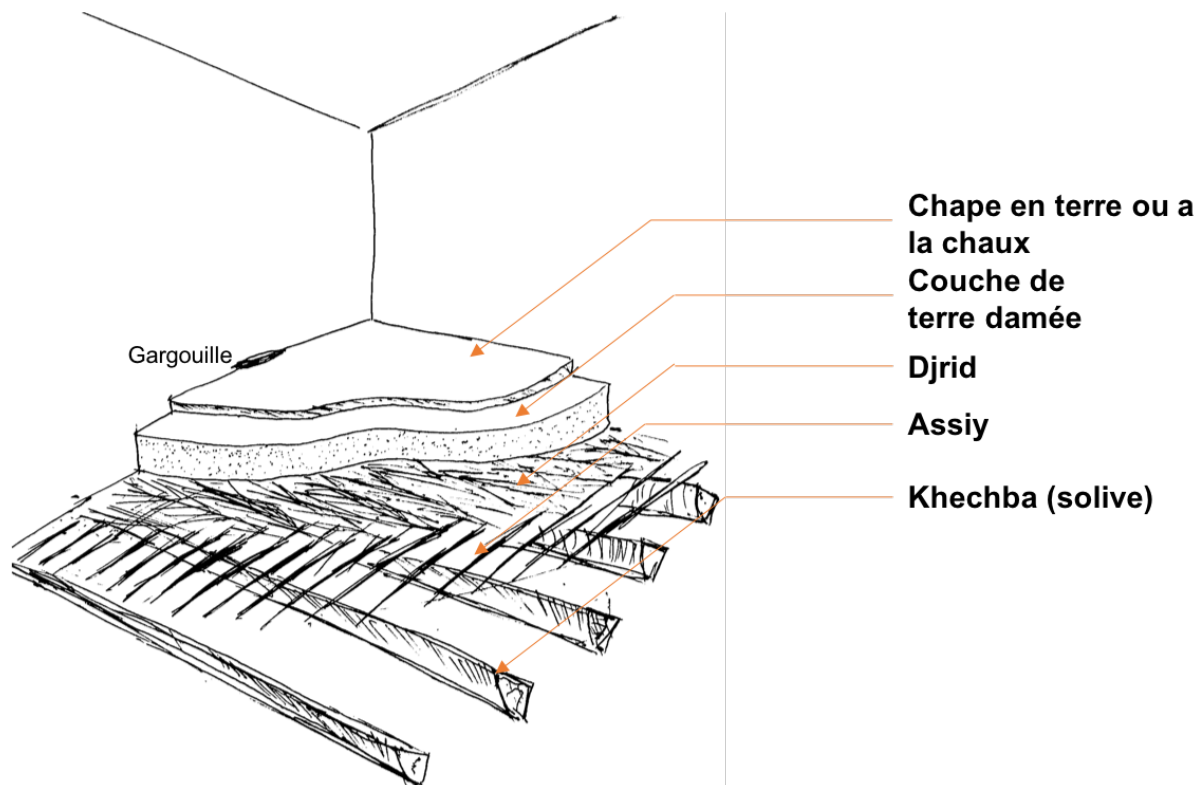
Éléments d'un plancher traditionnel à Timimoun
